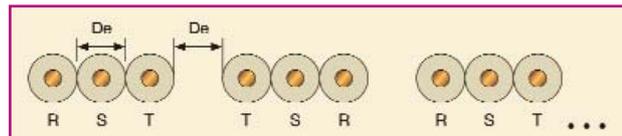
Disposição com os cabos de cada grupo RST posicionados lado a lado
